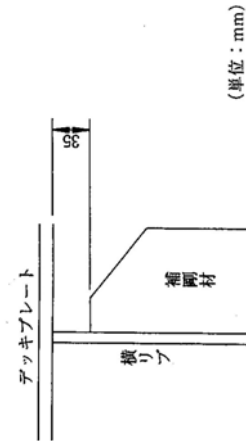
横リブ又は横桁の垂直補剛材の取付け構造の標準
